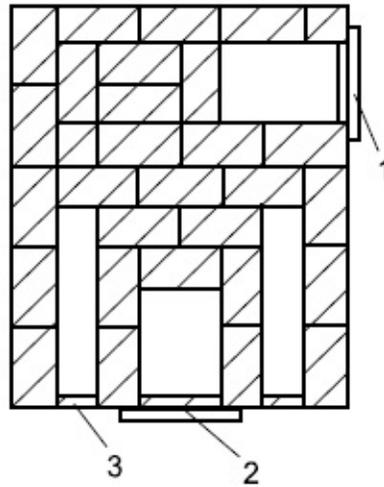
Кладка отопительно-варочной печи с камином: 1 – дверка поддувала; 2 – дверка золосборника; 3 – декоративные решетки воздухозаборника
